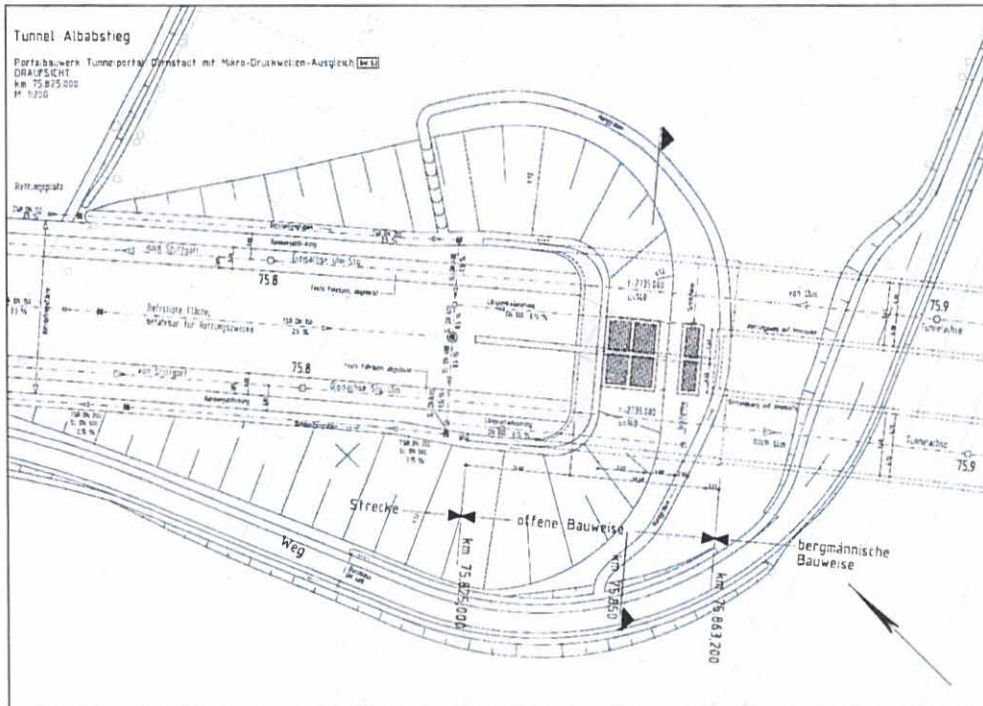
Lageplan (Ausschnitt) Portal Dornstadt [BGS06a]
